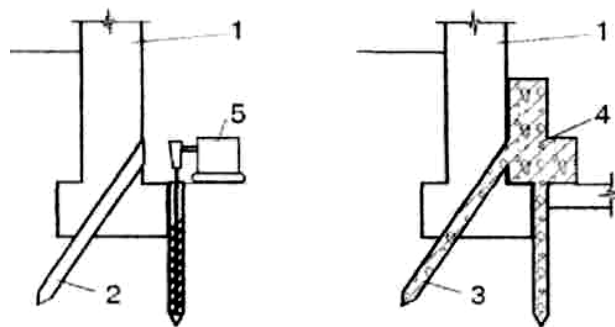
Схема підсилення фундаментів буро набивними палями:
